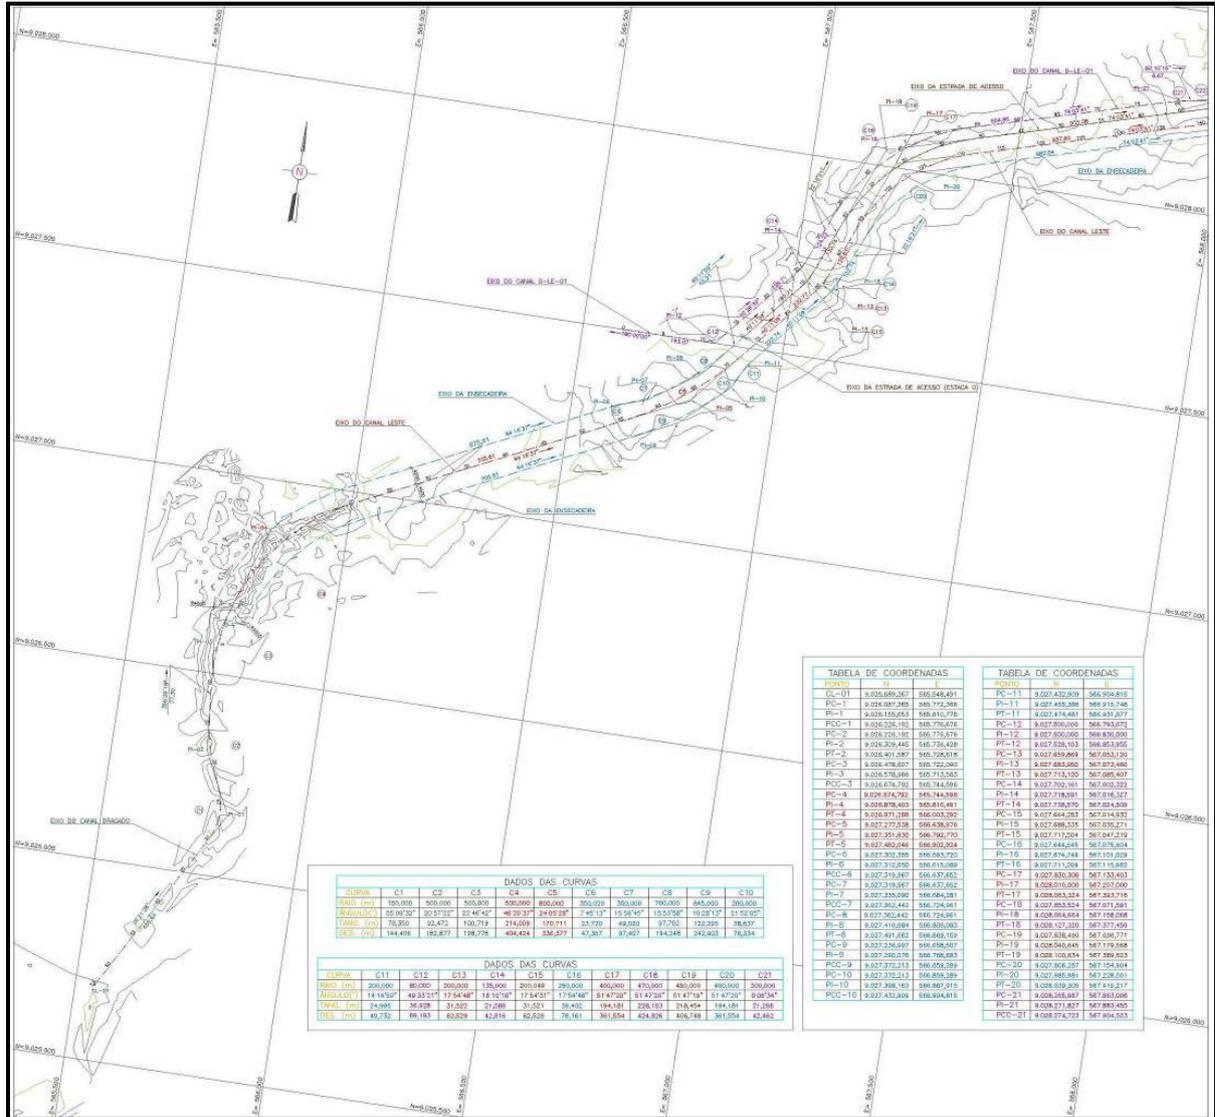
Levantamento planialtimétrico do canal de aproximação.
